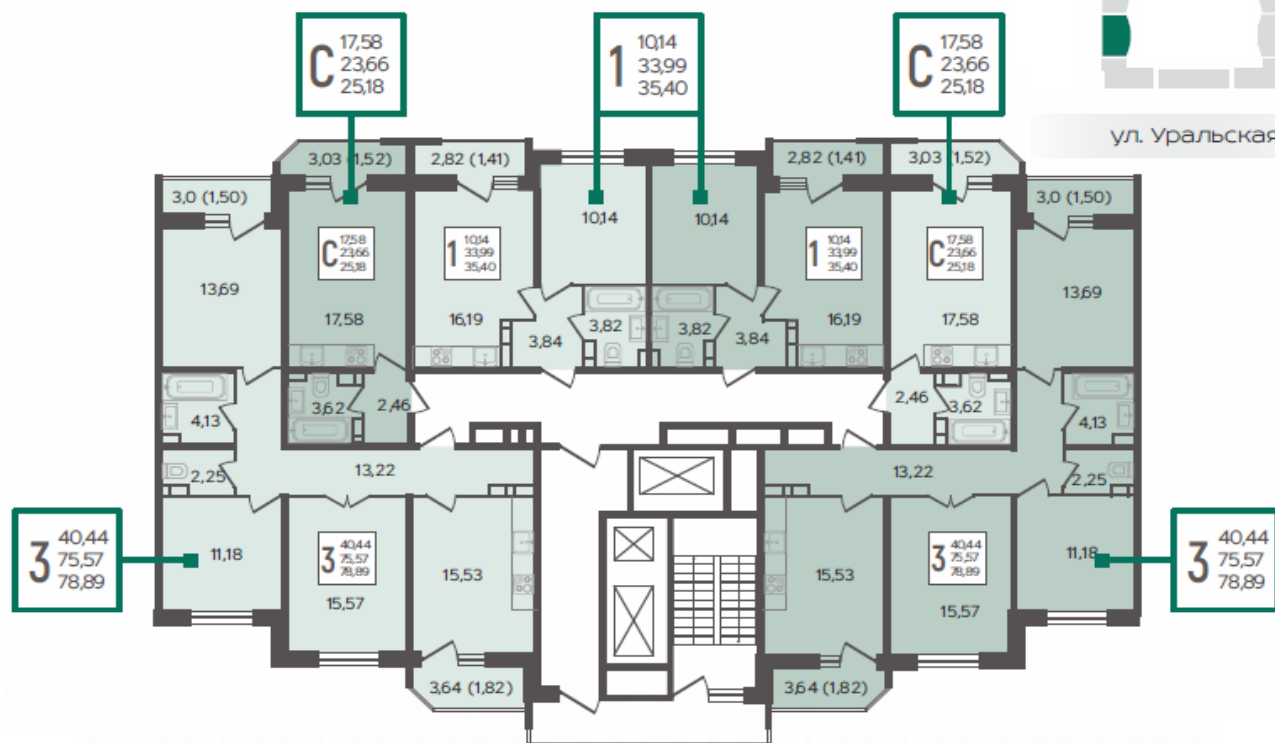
Типовой план 22-23 этажа БС-2 ЖК URAL
